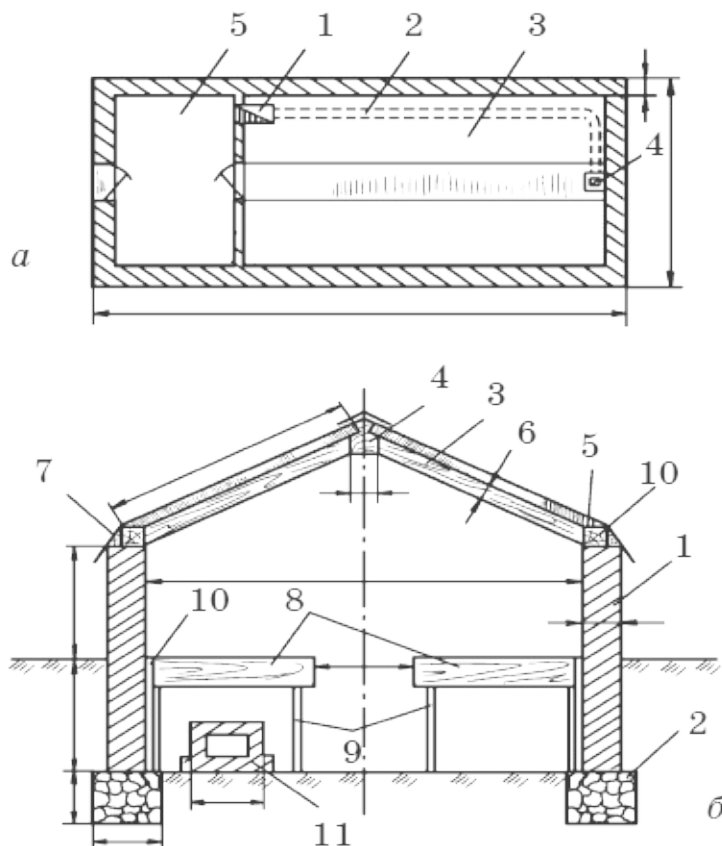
Зимняя двускатная теплица: а — план теплицы: 1 — печь; 2 — дымоход; 3 — стеллаж; 4 — дымовая труба; 5 — тамбур; б — схема двускатной теплицы (разрез): 1 — стена; 2 — фундамент; 3 — стропила; 4 — коньковый брус; 5 — обвязочный брус; 6 — паз для упора рам; 7 — отлив; 8 — стеллаж; 9 — стойка стеллажа; 10 — зазор между стойкой и стеллажом; 11 — дымоход
